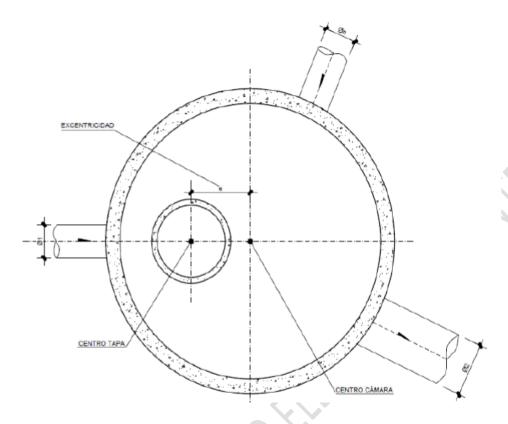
Vista en planta de las cámaras con distancia de excentricidad mayor al radio de la tapa.
